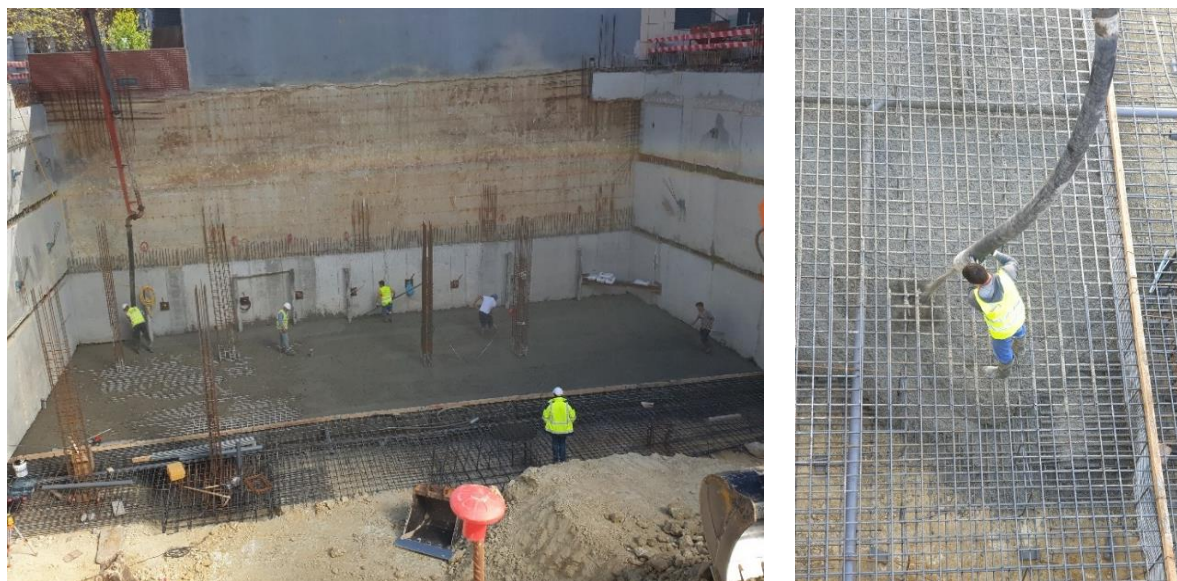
Betonagem através de auto-bomba da laje de ensoleiramento
